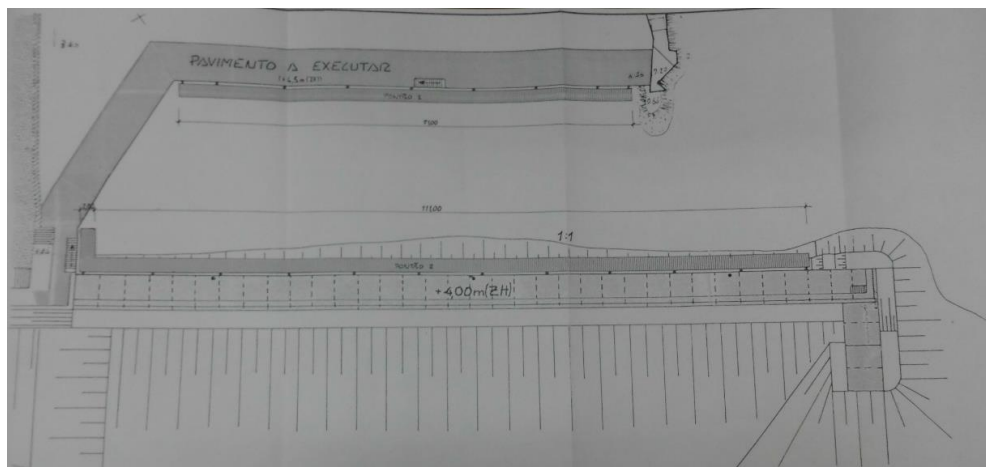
Planta geral do porto de recreio de Santa Cruz.
